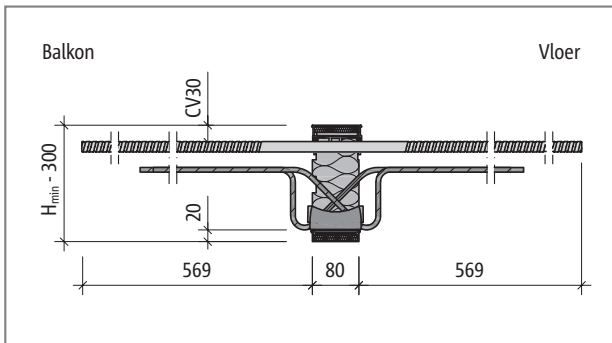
Schöck Isokorb® CT type K-T-M3-V2-CV30: bovenaanzicht
